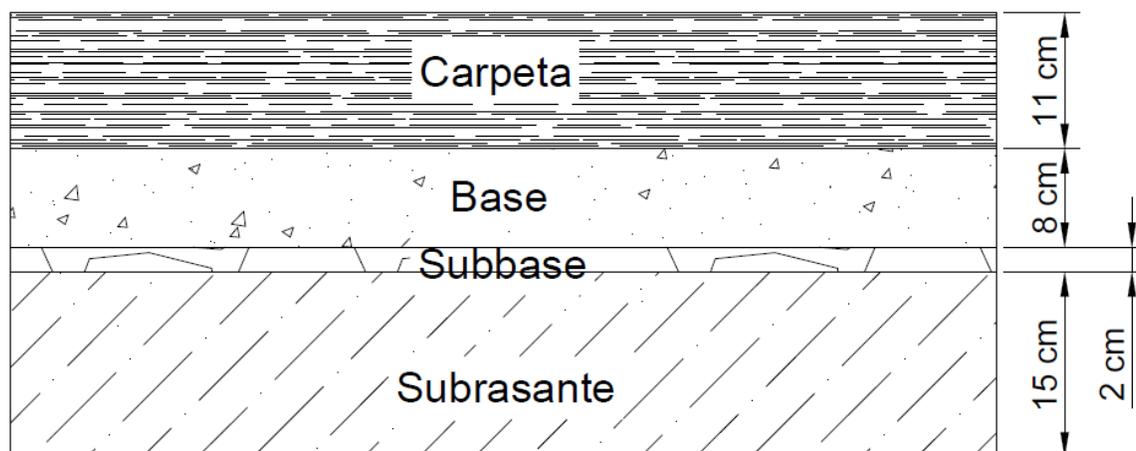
Estructura de pavimento resultante en el cálculo.
